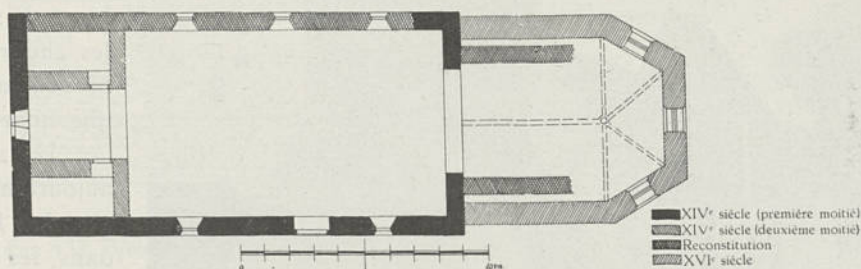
Breissem, Eglise Saint-Corneille, plan terrier
